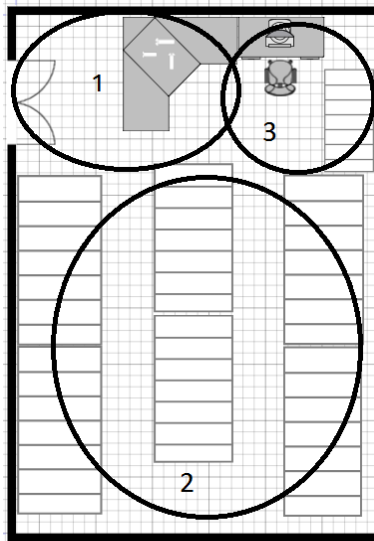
Planta dos armazéns da empresa Sistecaut Lda.
